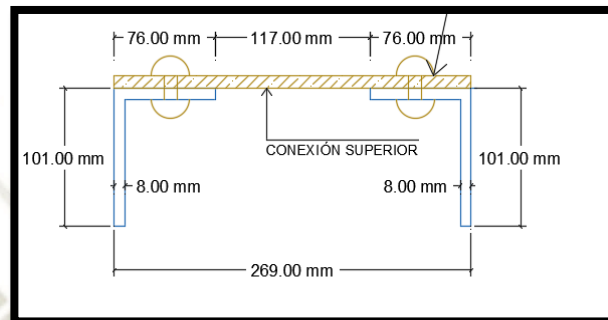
Arriostre en pilares, formado por sección compuesta C4
